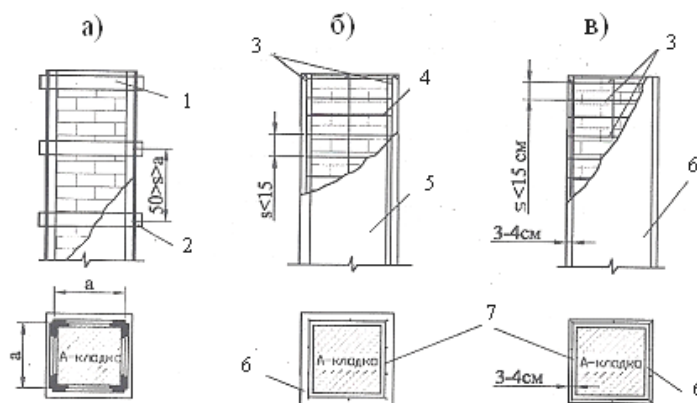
Усиление кирпичных колонн и столбов с помощью устройства металлического каркаса (а), железобетонной (б) обоймой или армированной штукатуркой (в):
